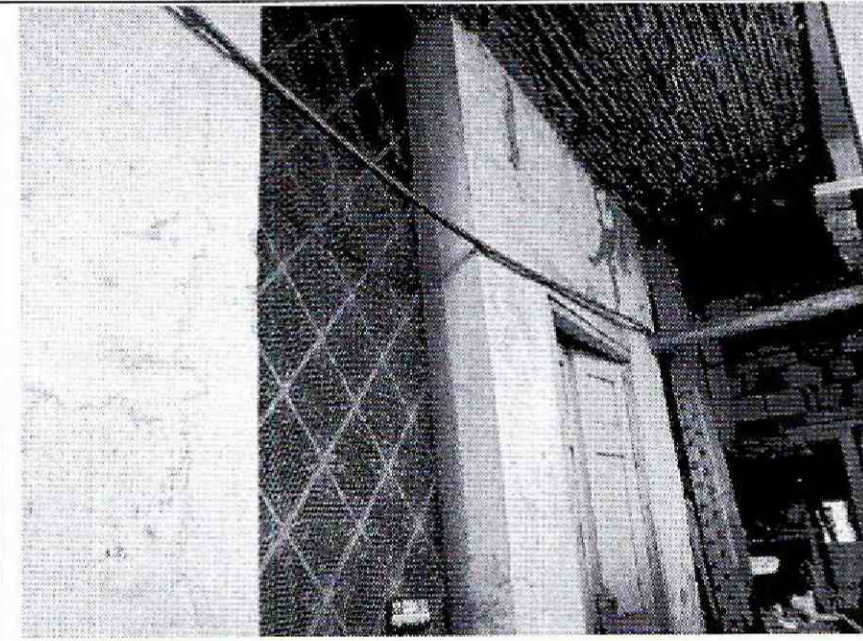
Estructura de soporte de cubierta con deterioro.
